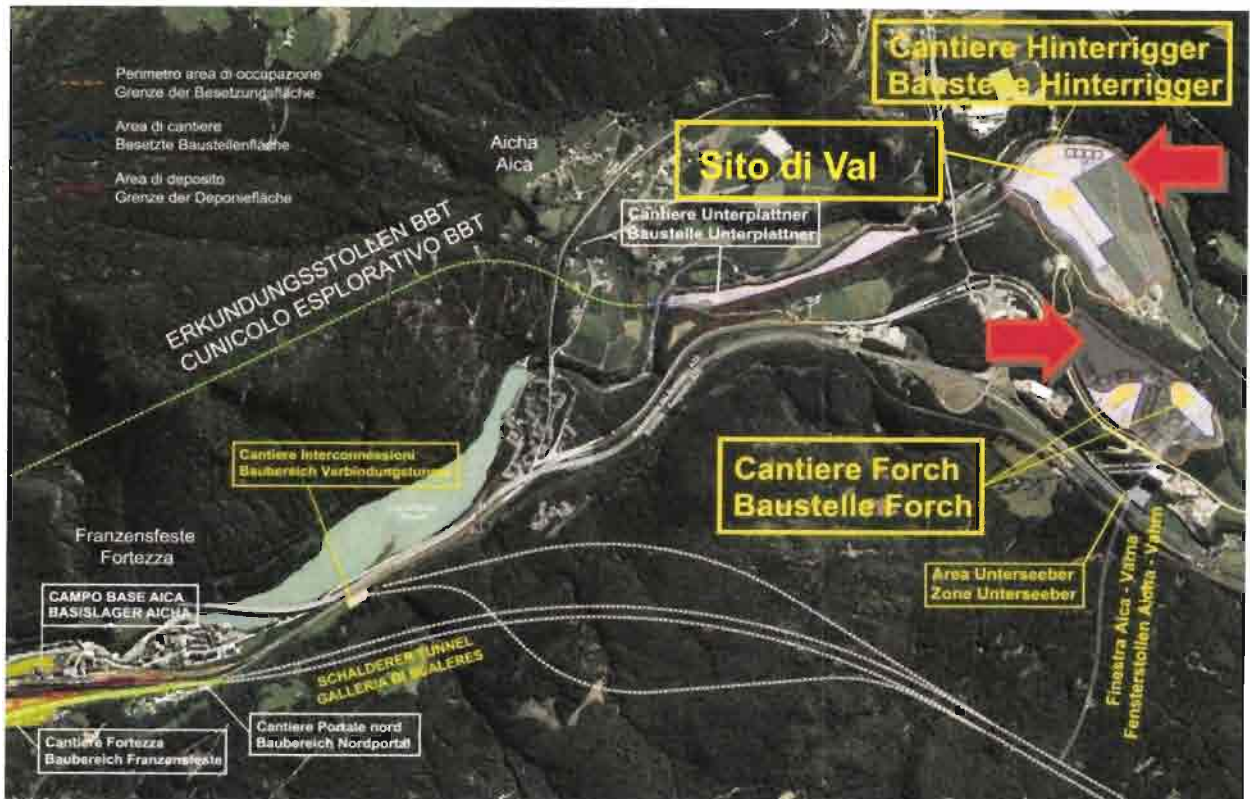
Area di cantiere in Val di Riga – panoramica aree Unterplattner- Hinterrigger e Forch (dalla relazione di Ottemperanza del progetto della Galleria di Base)
